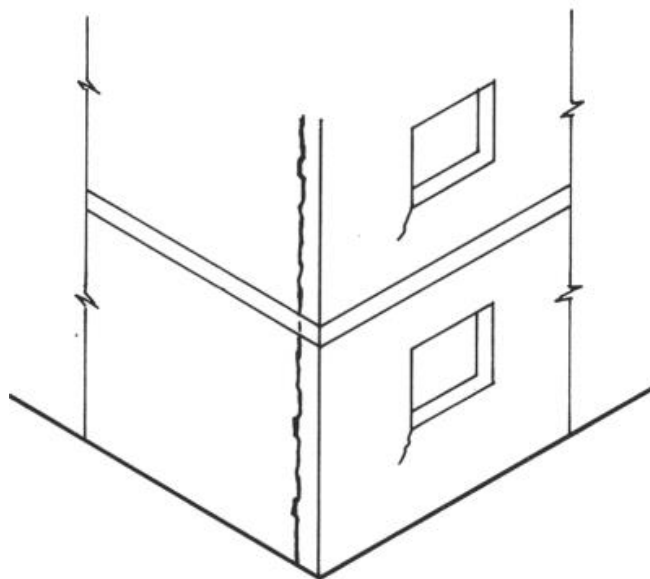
Fissuras verticais junto a pilares (DUARTE, 1998).
